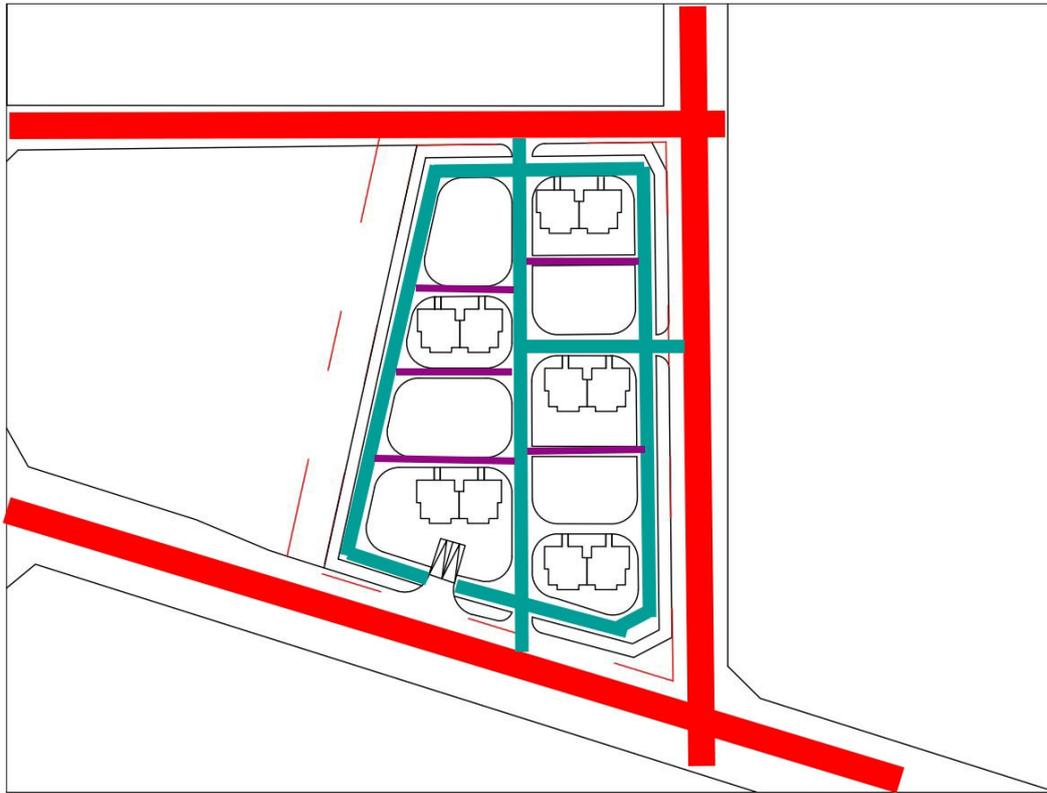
Distribuzione delle strade e impostazione degli ingressi e delle uscite nella zona sud di Zaozhuang
